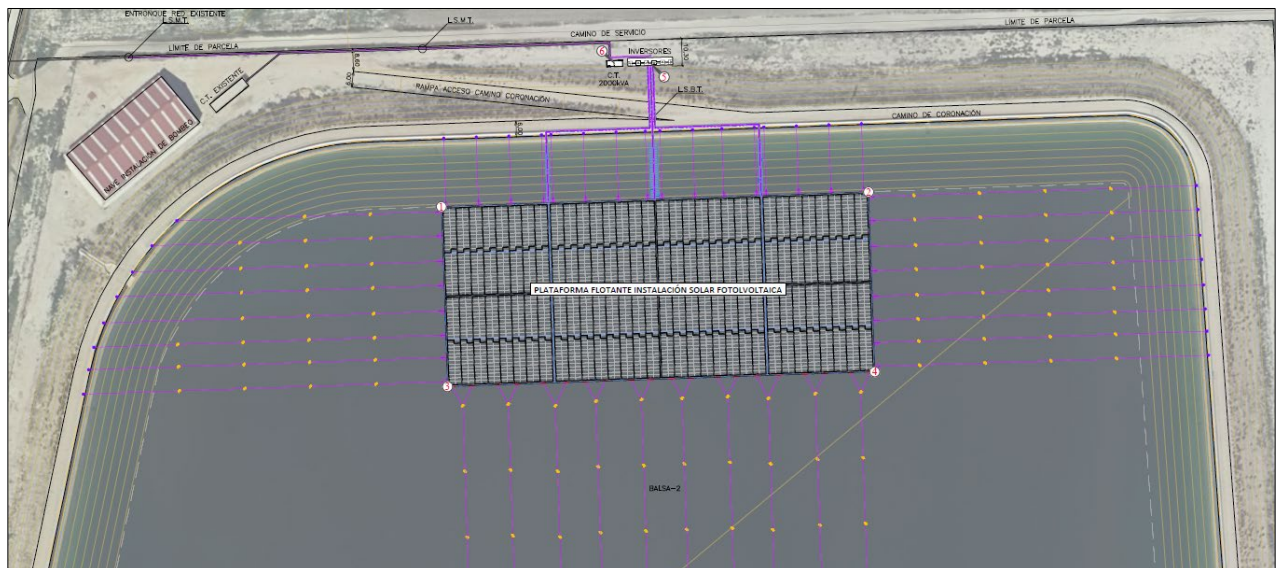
Ubicación de las instalaciones de la planta fotovoltaica en la balsa n.º 2.
